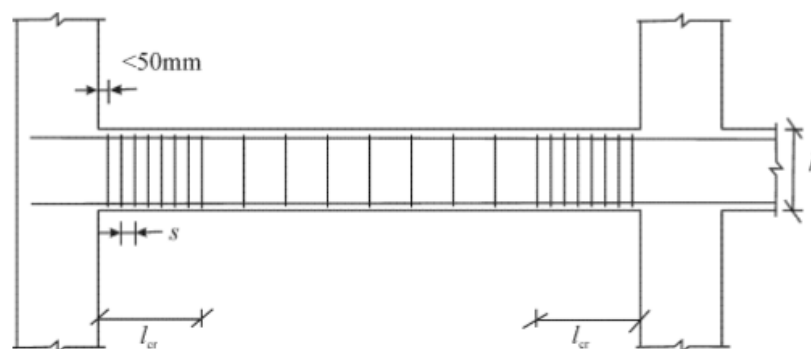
Armaduras transversais nas zonas críticas das vigas.
